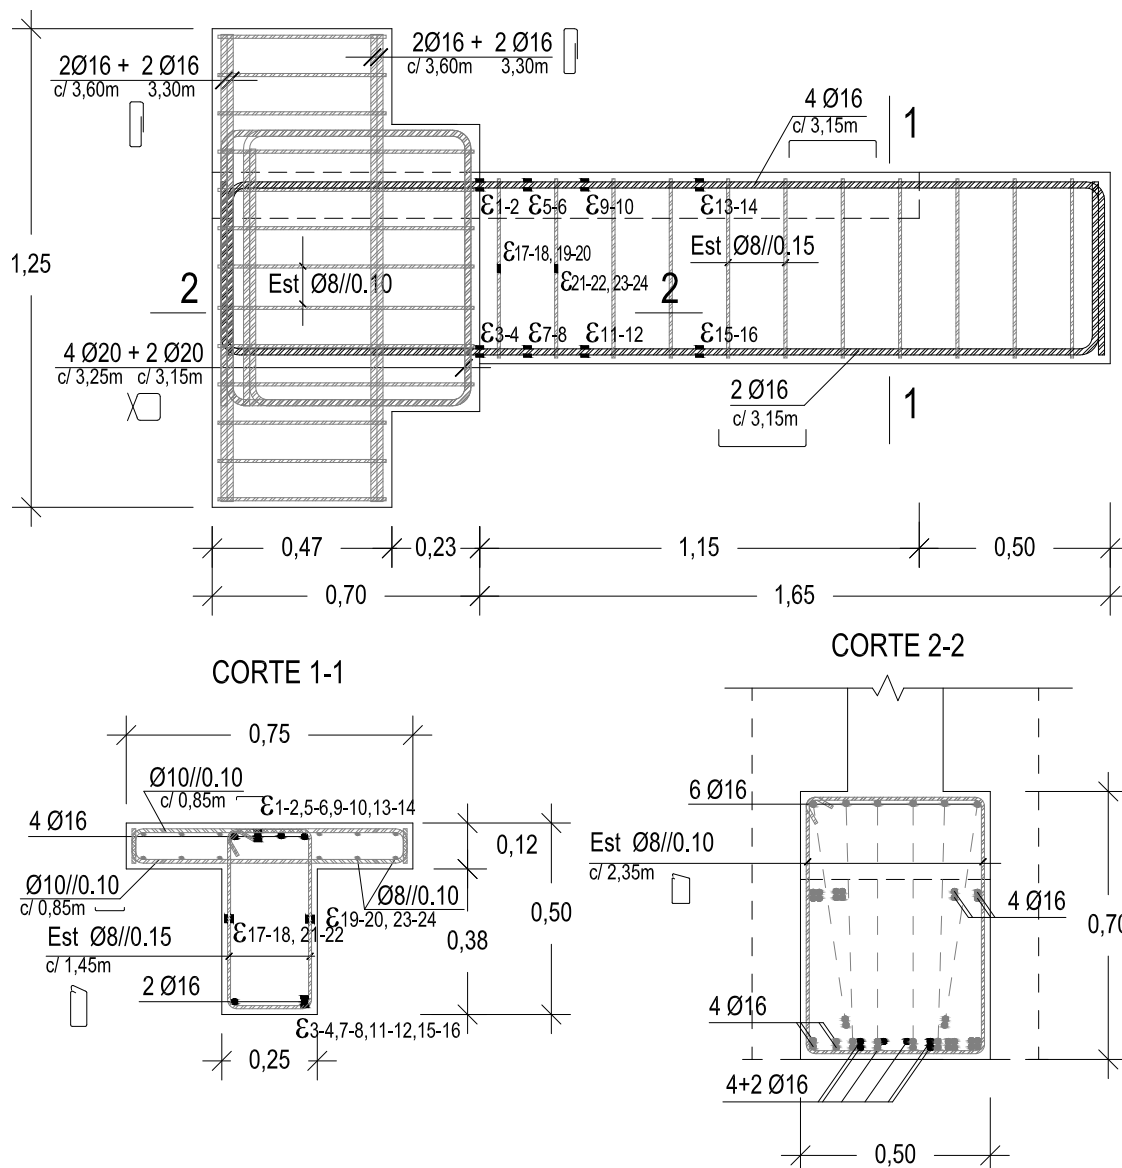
Modelo de referência – Pormenorização e instrumentação das armaduras em aço A400NR
